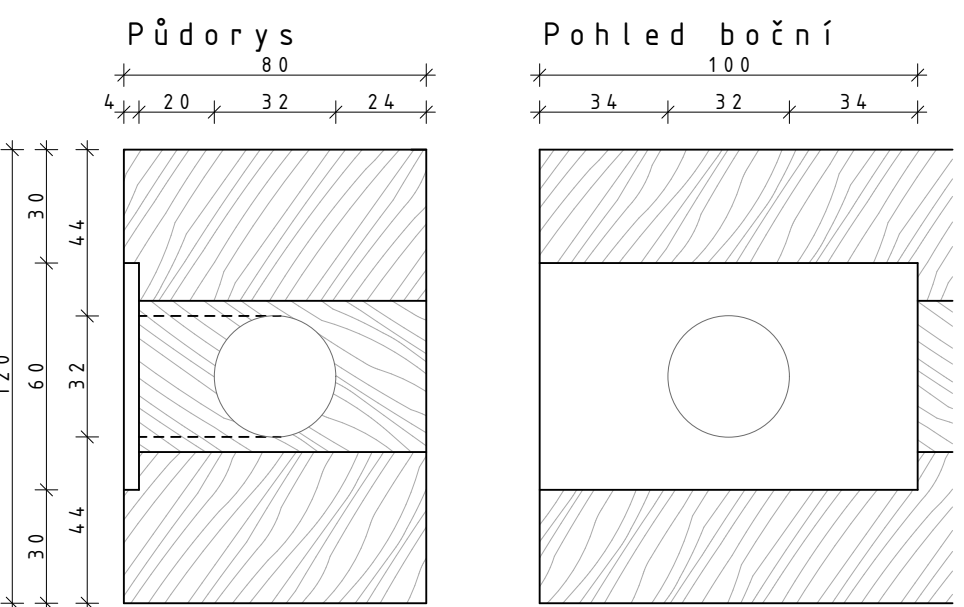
DETAIL UKOTVENÍ OTÁČIVÉ LAMELY - M 1:10
